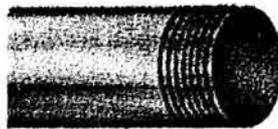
Tubería conduit pared gruesa galvanizada.
